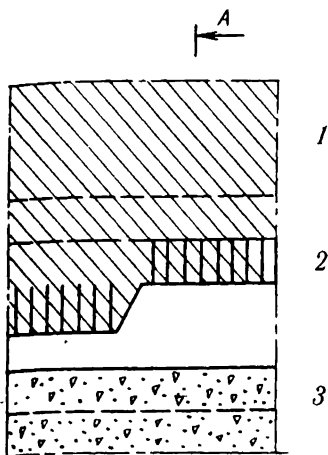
Система разработки мягких пластов гидравлическим способом с креплением нарезных выработок анкерной крепью
